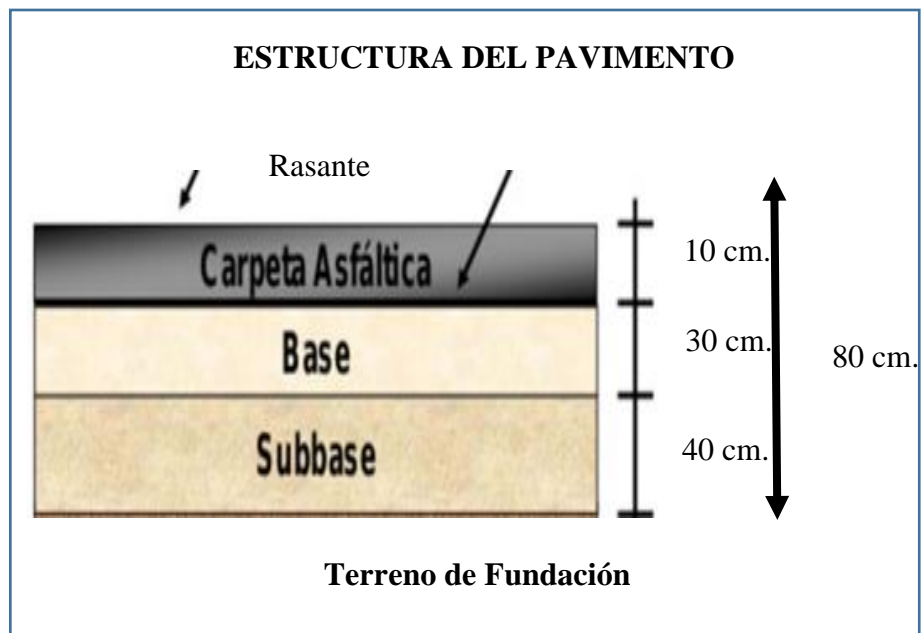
Estructura del pavimento, según mepdg. Aashto 2008
